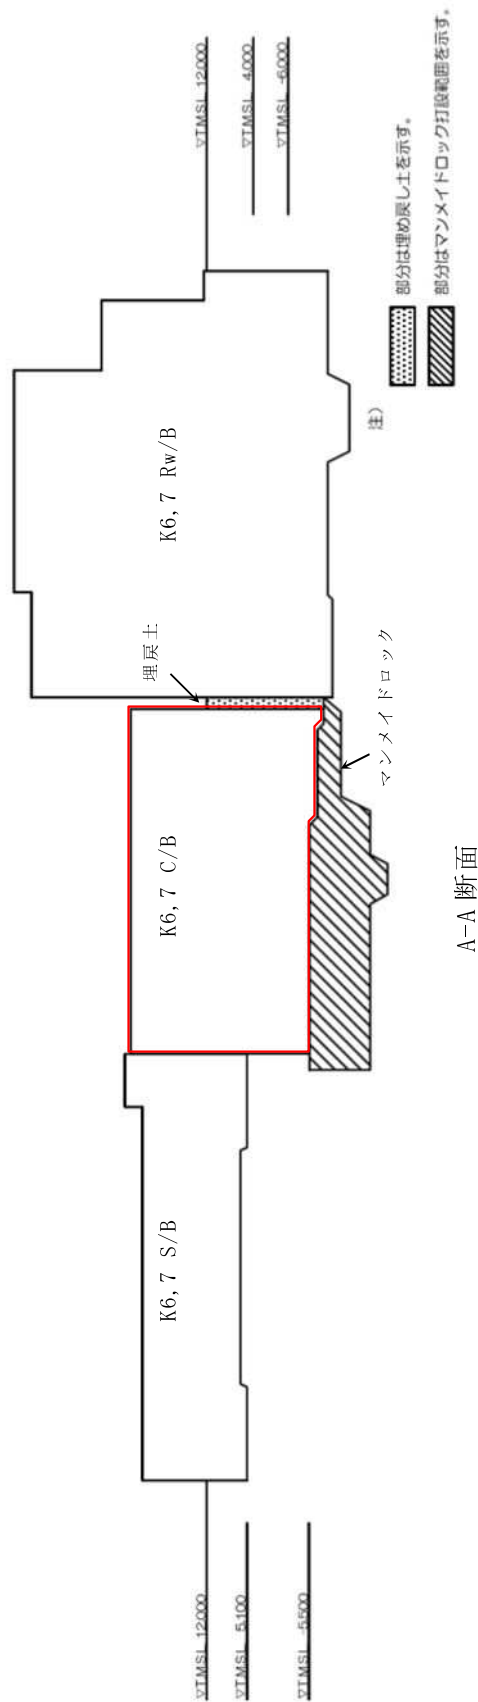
コントロール建屋の設置状況 (断面図) (単位: mm)
